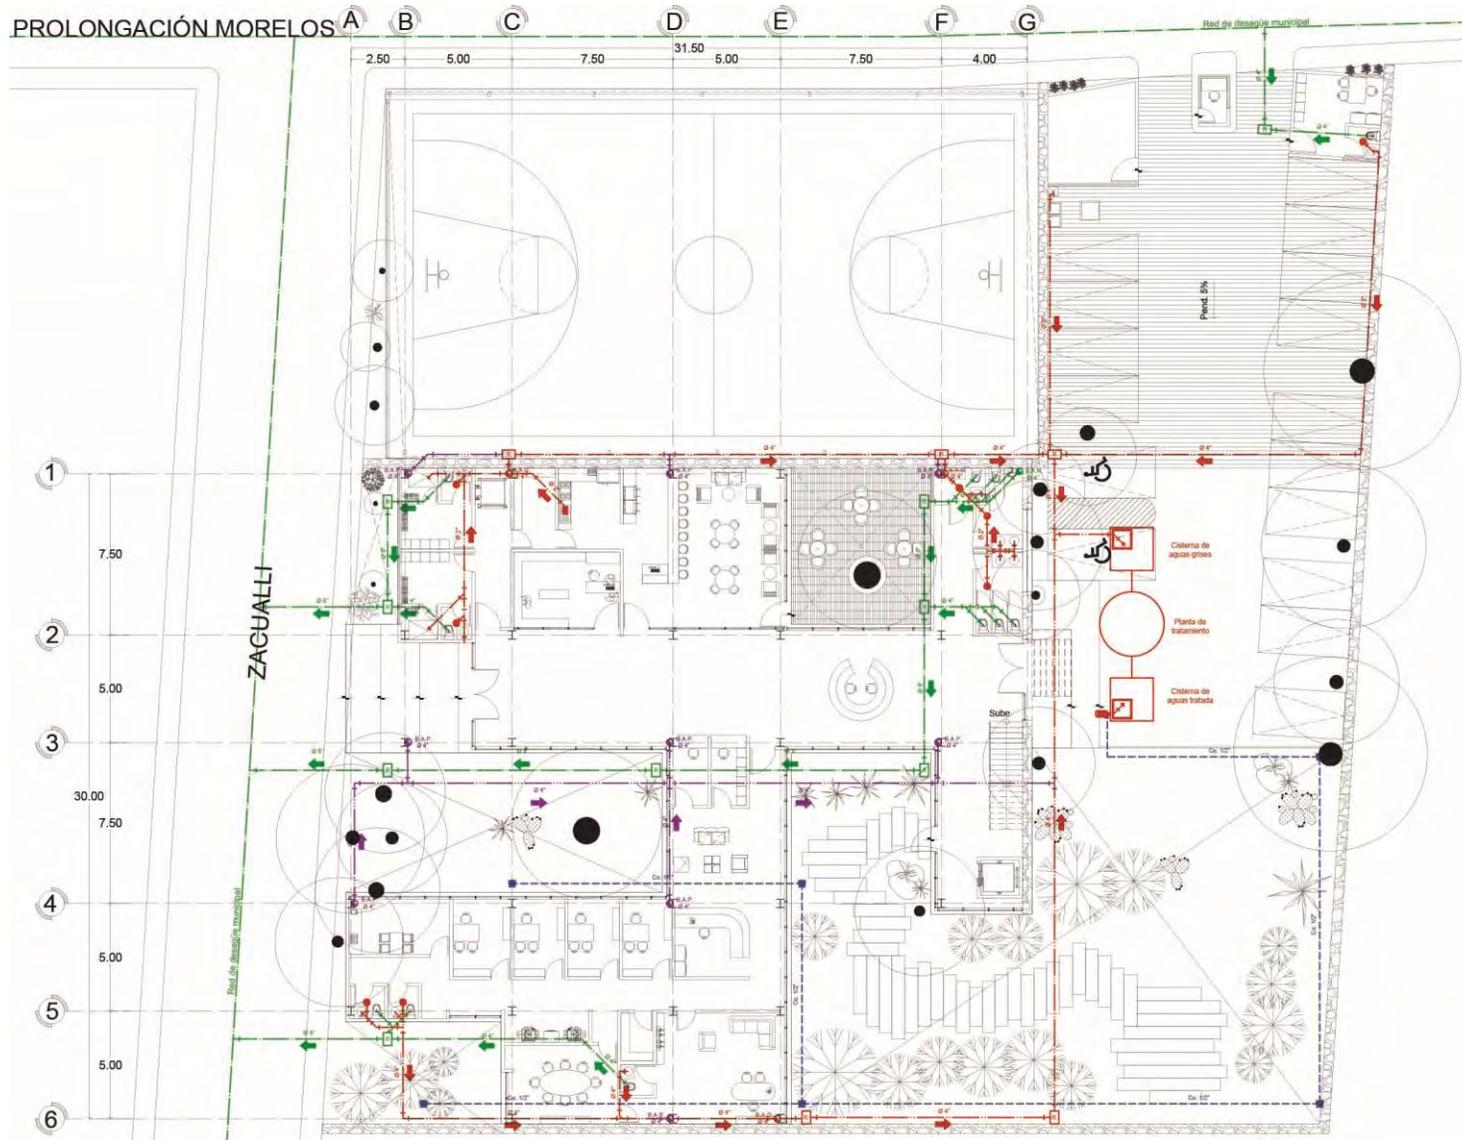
Planta baja. Desarrollo y separación de ramales para aguas residuales del proyecto.
